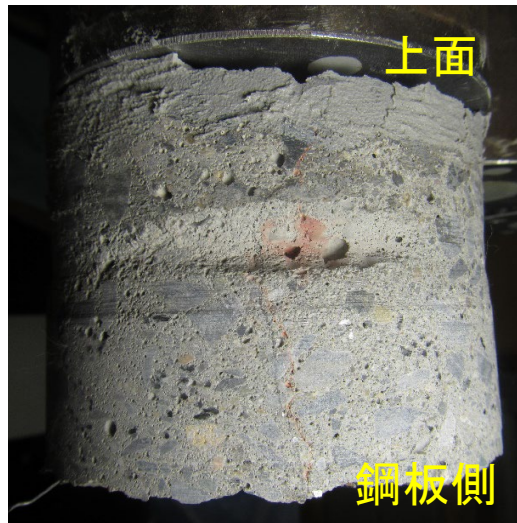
ひび割れ部④の側面の観察状況
